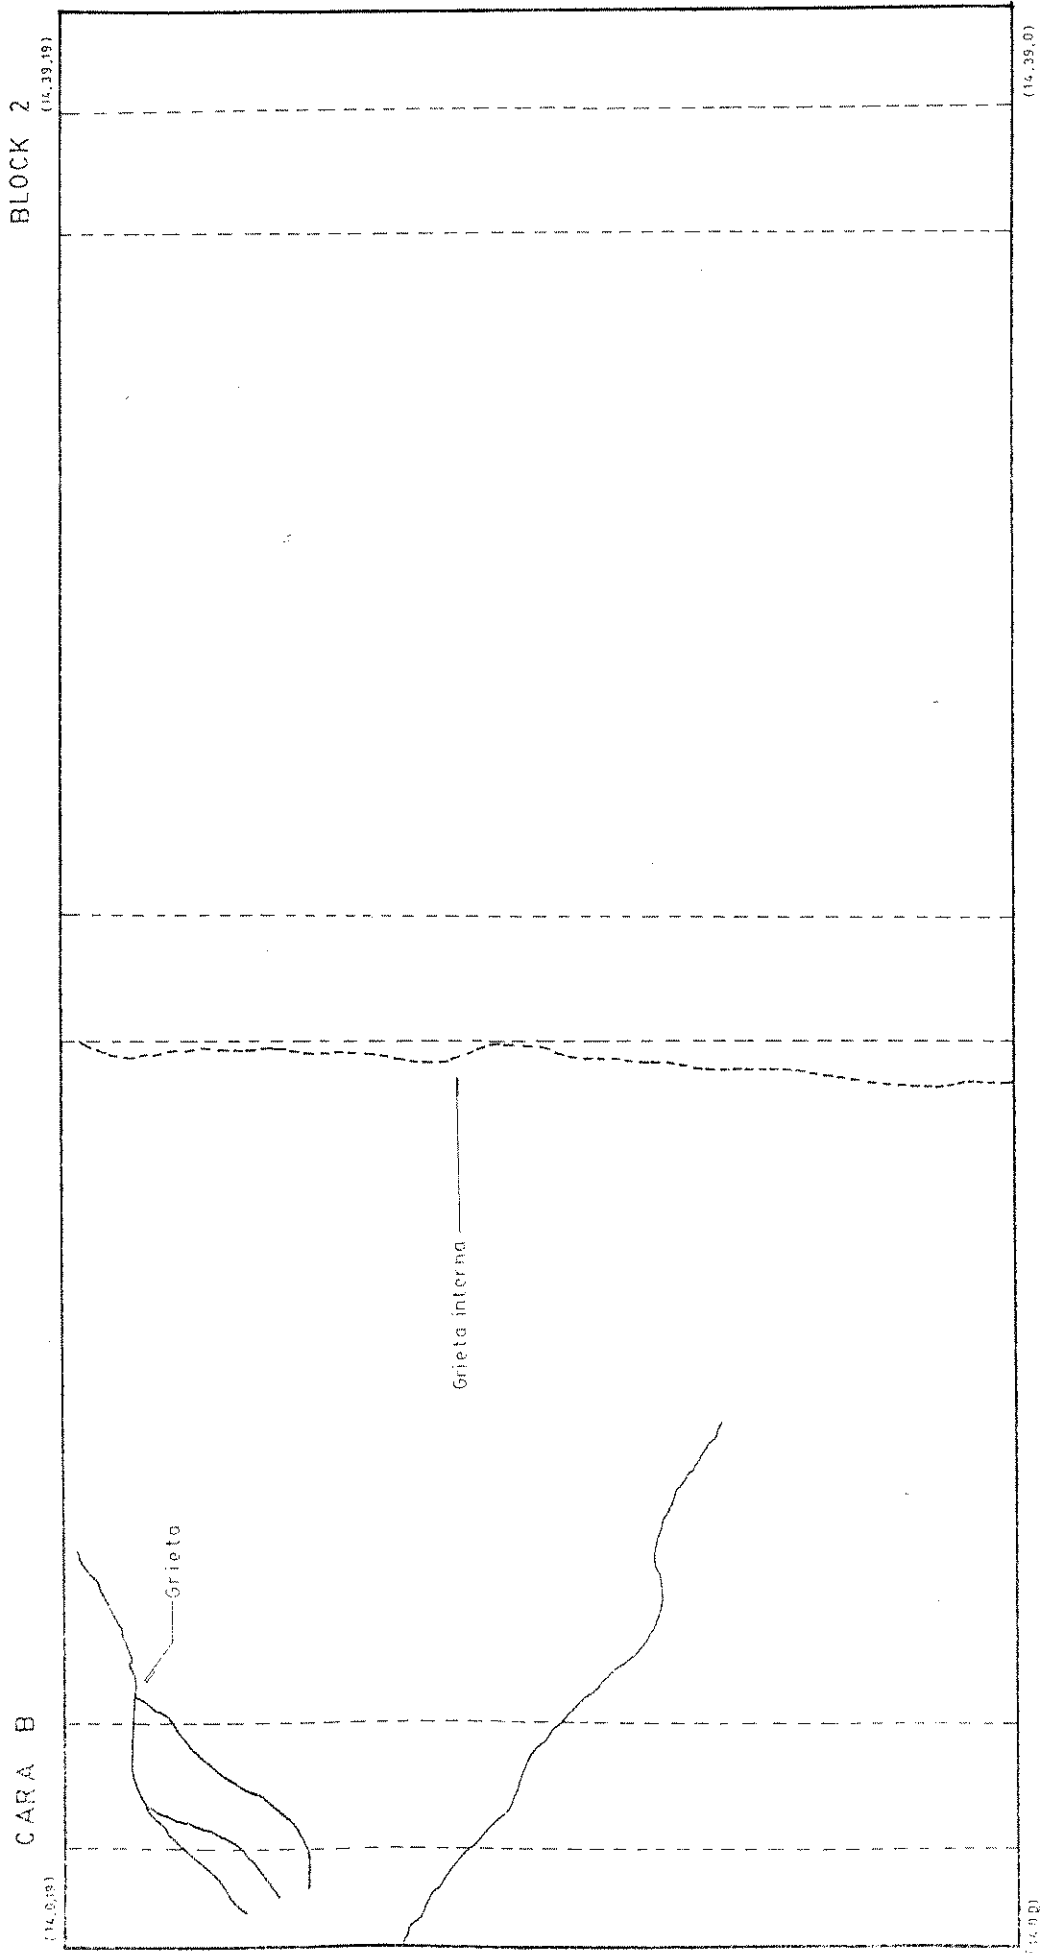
Grieta ocurrida por la carga de corte en el segundo block ensayado.
